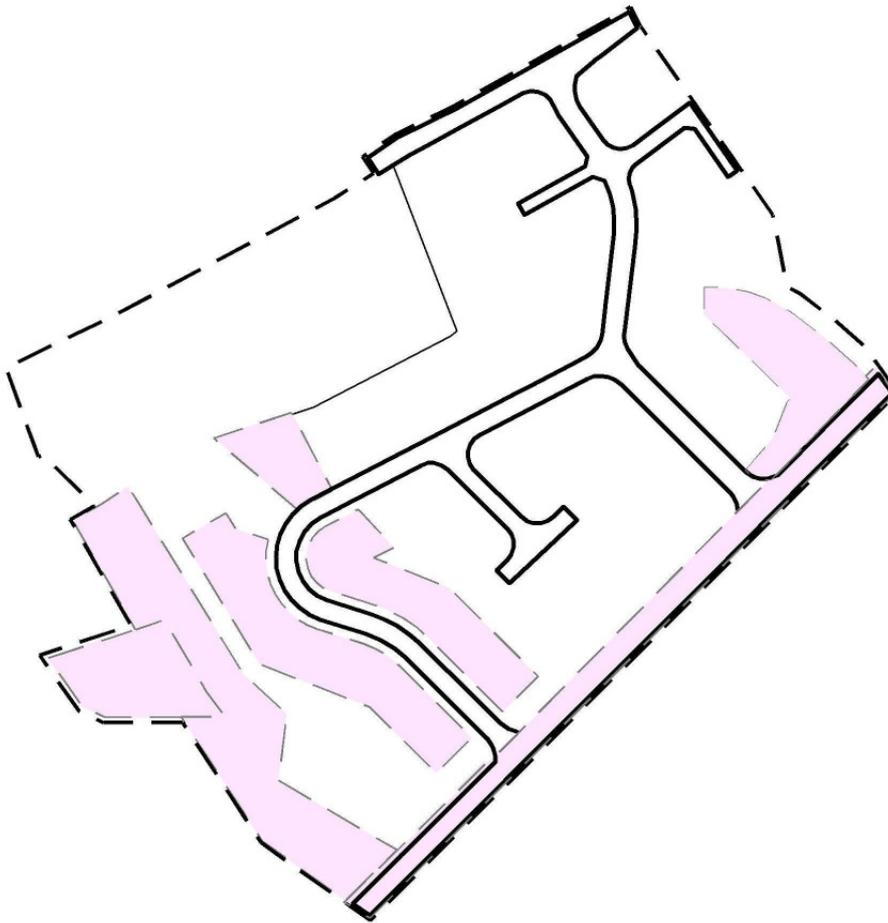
Übersichtsplan mit Darstellung der Änderungsbereiche
